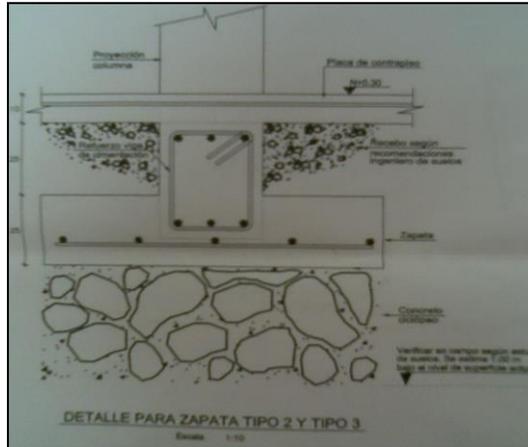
Diseño de la zapata de tipo 2 y tipo 3 Bloques A y B.
